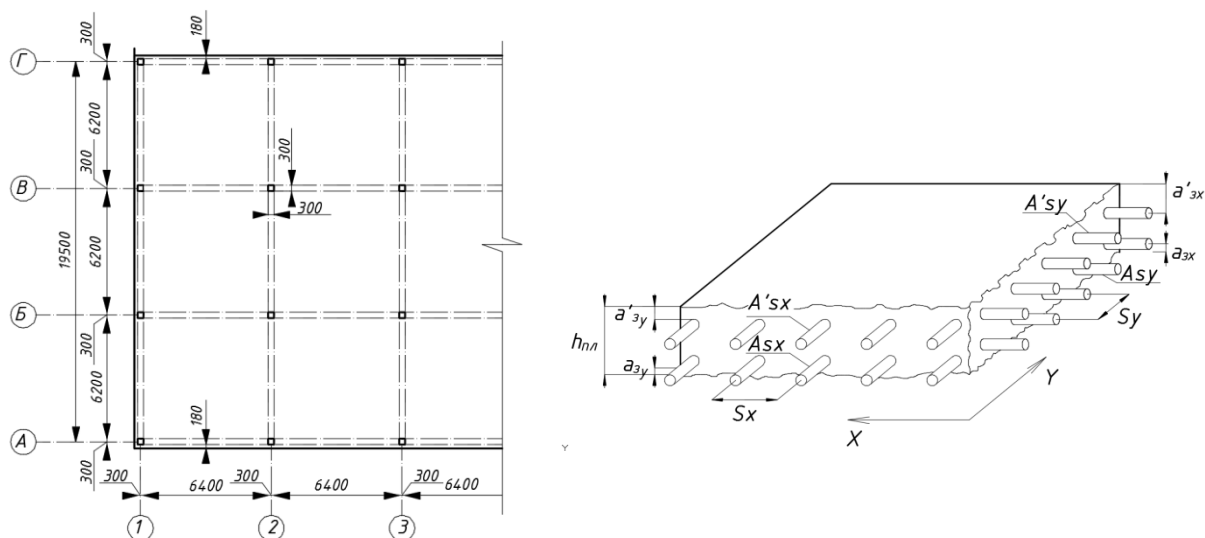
Схемы рассматриваемой системы перекрытия и подбираемого армирования плиты
